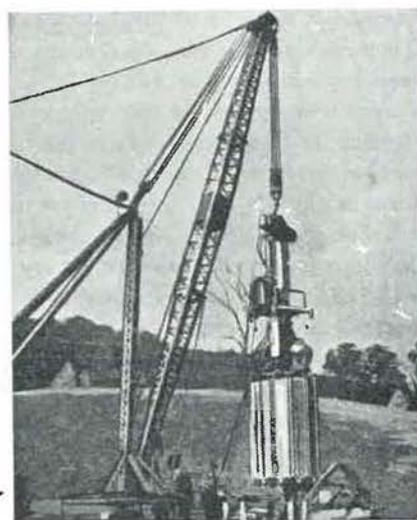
Vue de la machine remontée en surface par la grue avant l'extraction de la carotte.
